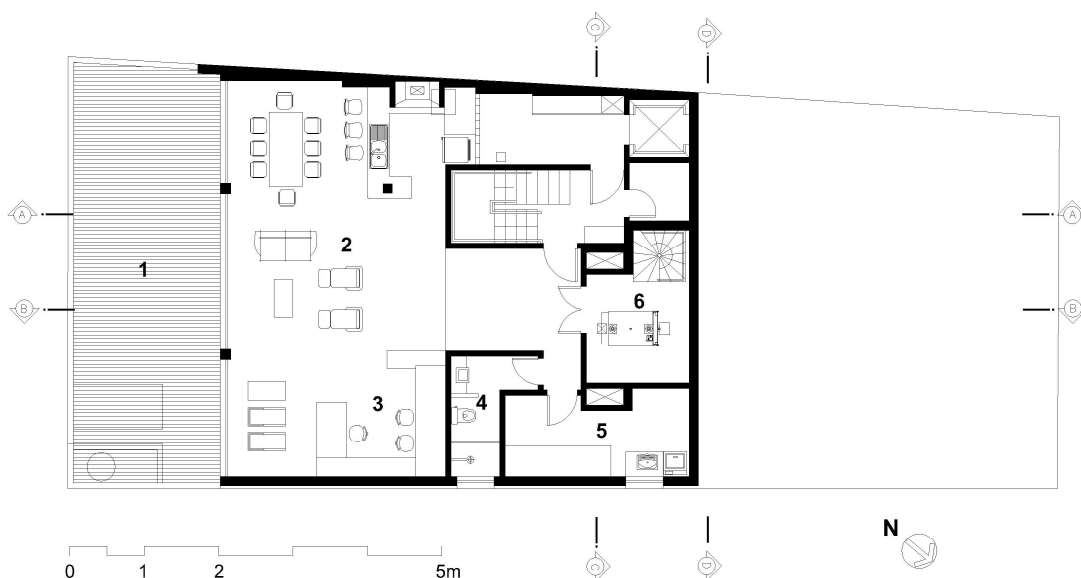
Planta do primeiro pavimento [bloco residencial]; (1) deck, (2) salão de festas, (3) ateliê, (4) banheiro; (5) lavanderia, (6) espaço técnico – caldeira.
